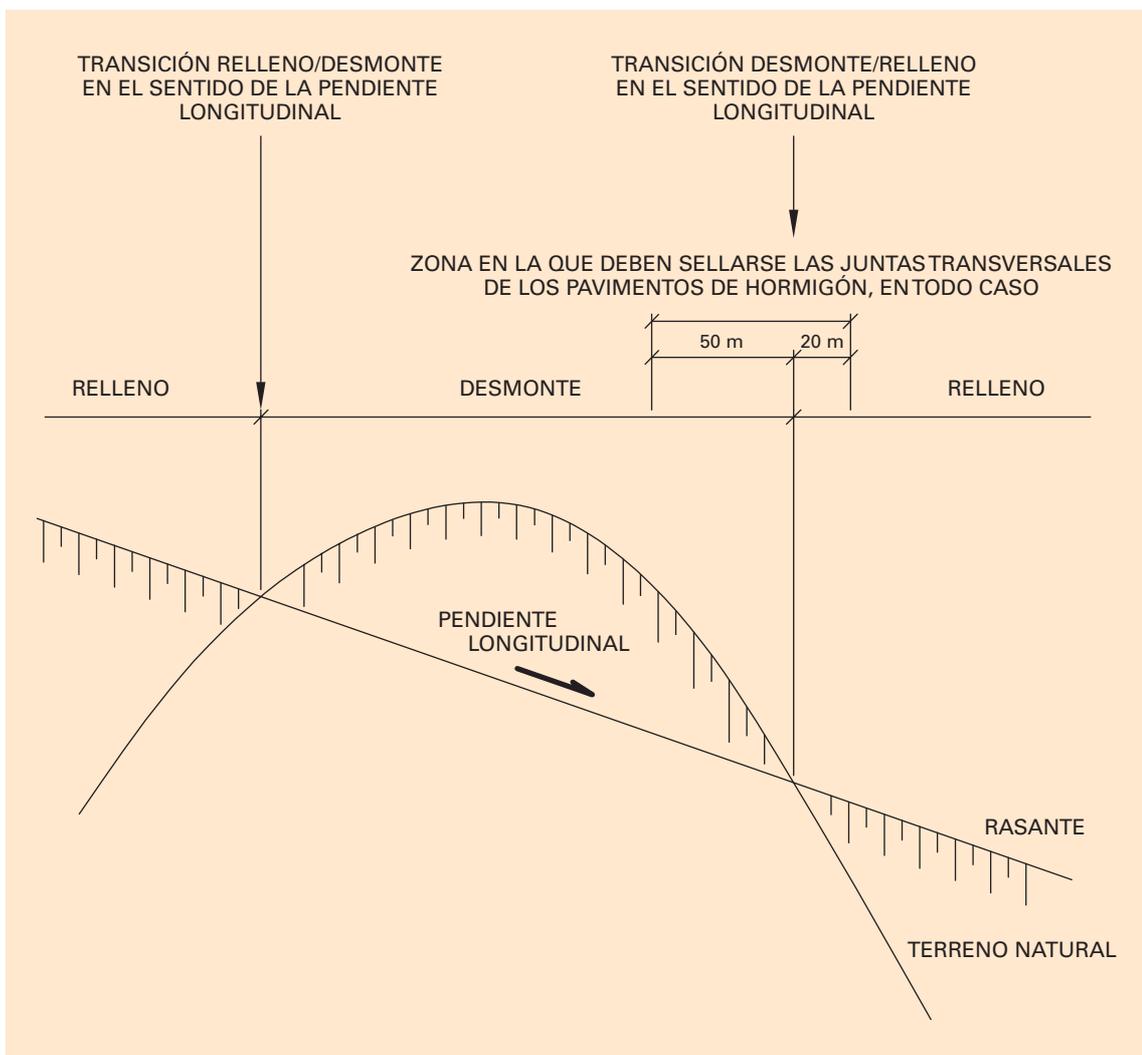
SELLADO DE JUNTAS TRANSVERSALES EN PAVIMENTOS DE HORMIGÓN EN TRANSICIONES DESMONTE-RELLENO
